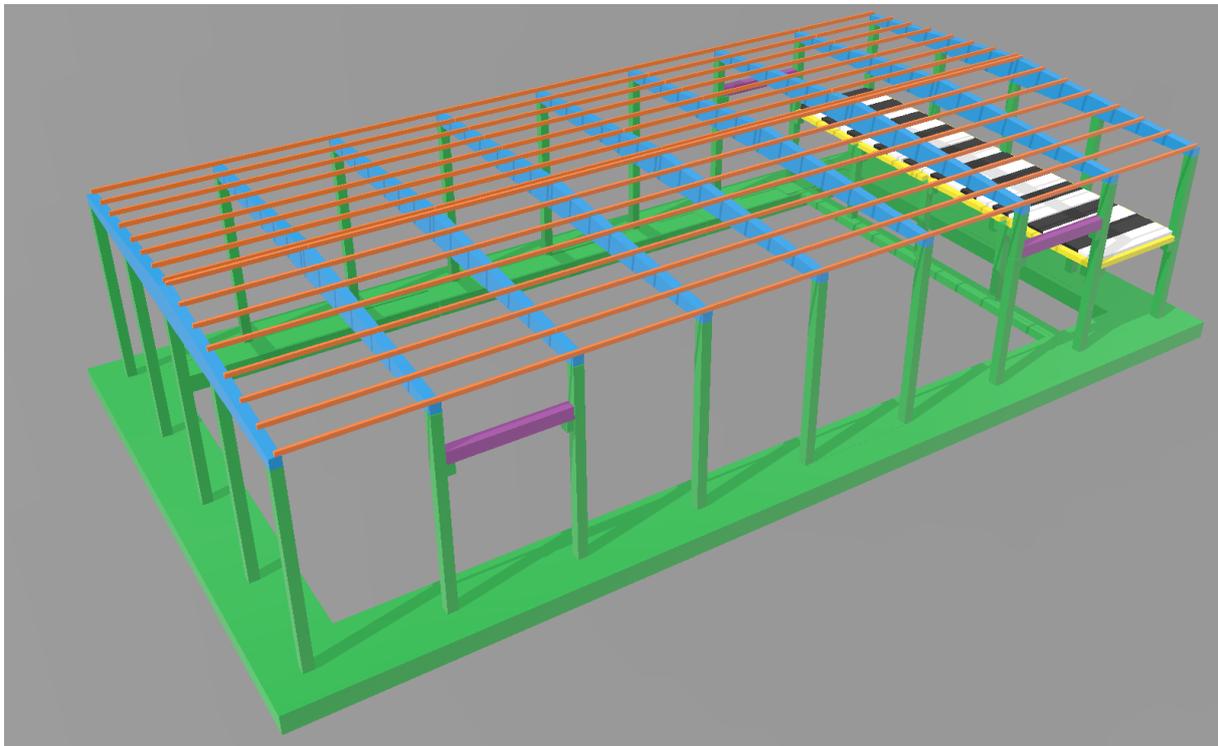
35 Paso 6: Colocación de las viguetas VI 18 [3D Builder, 2019]
